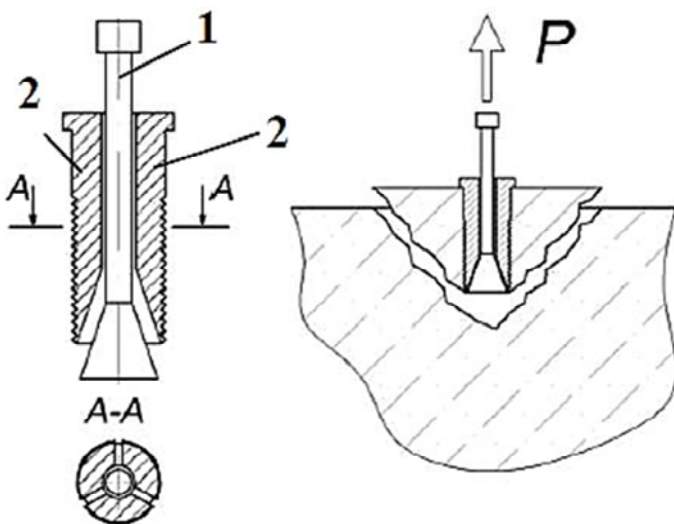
Схема испытаний методом отрыва со скалыванием:
